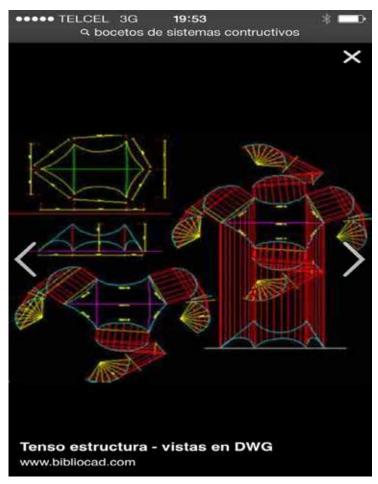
Boceto de sistemas constructivos en una Tenso estructura. Fuente: www.bibliocad.com
